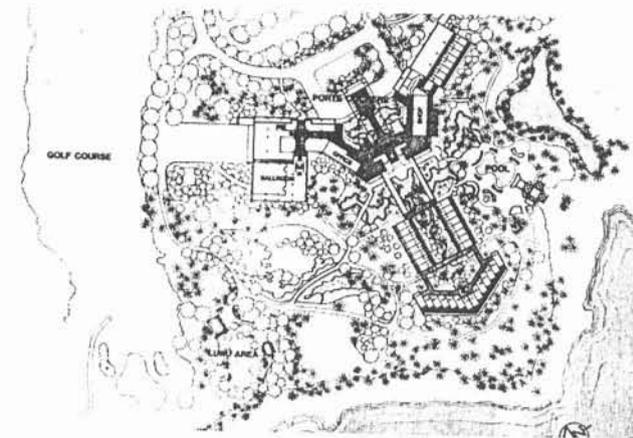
Mauna Laine Bay, Killingsworth, & Assoc., Big Island, Havai. Vista interna e implantação.
